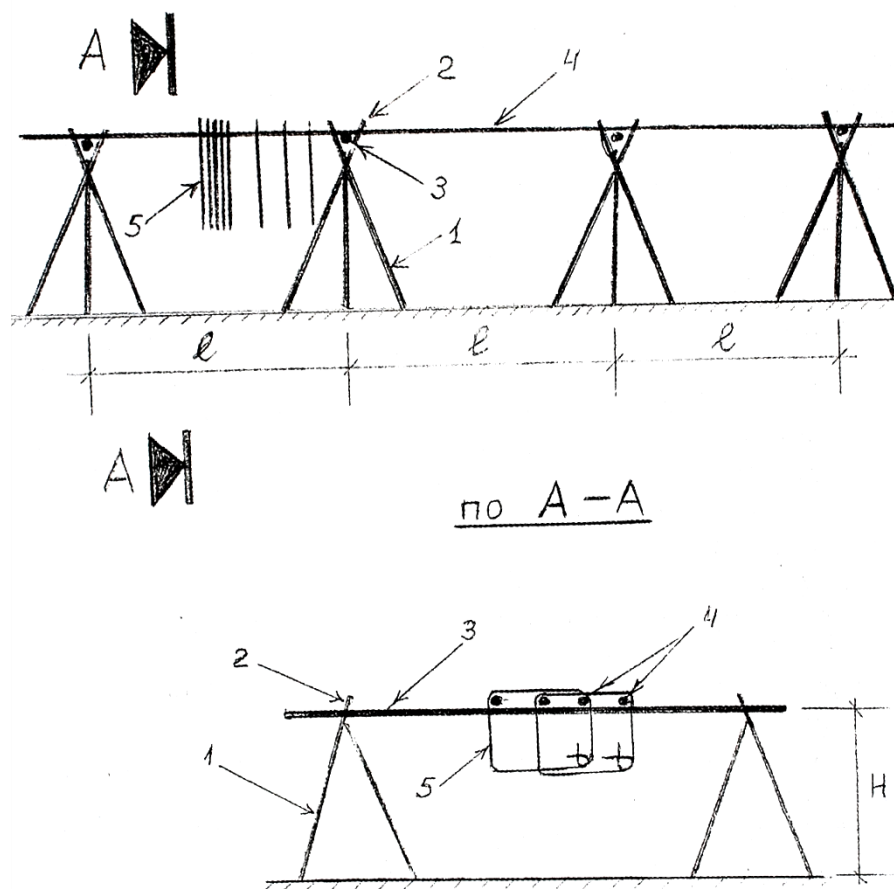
Технология полигонного изготовления пространственных арматурных каркасов колонн, ригелей, балок: 1 и 2 – тренога, 3 – перекладина съёмная из арматуры класса А-П, диаметром 22 мм, 4 – рабочие арматурные стержни пространственного каркаса; 5 – хомуты каркаса; H – высота сборочного стенда H= 1,2 м.
